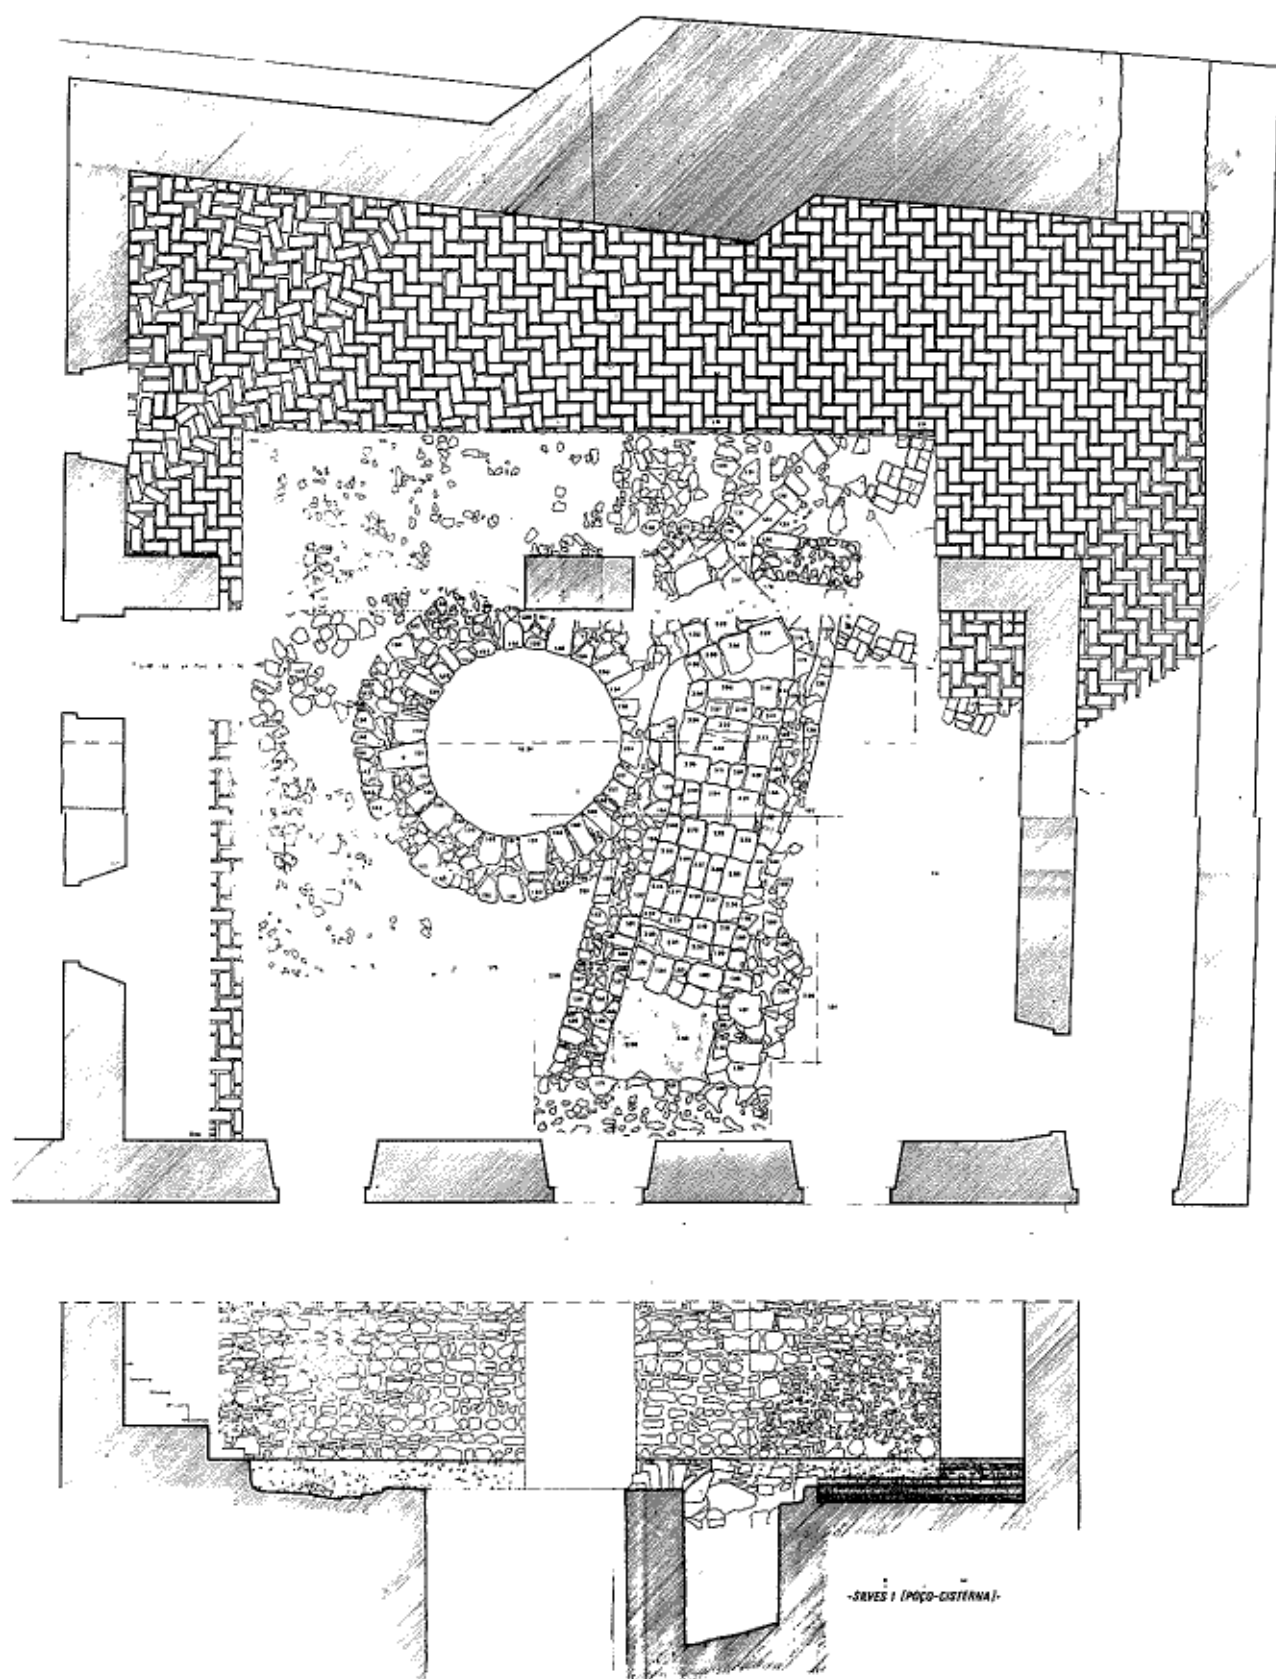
Planta e corte do poço-cisterna de Silves.
